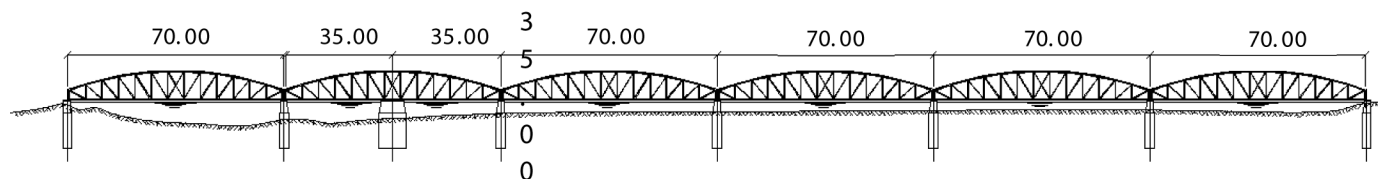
a : Elévation et coupe longitudinale du pont-rails de Zifta.
